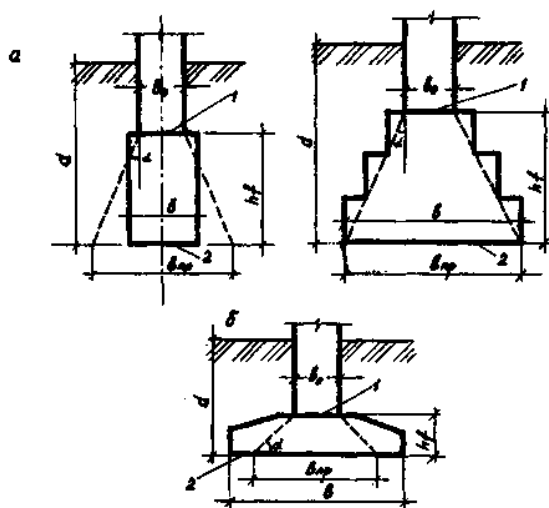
Конструкция жестких (а) и гибких (б) фундаментов:
